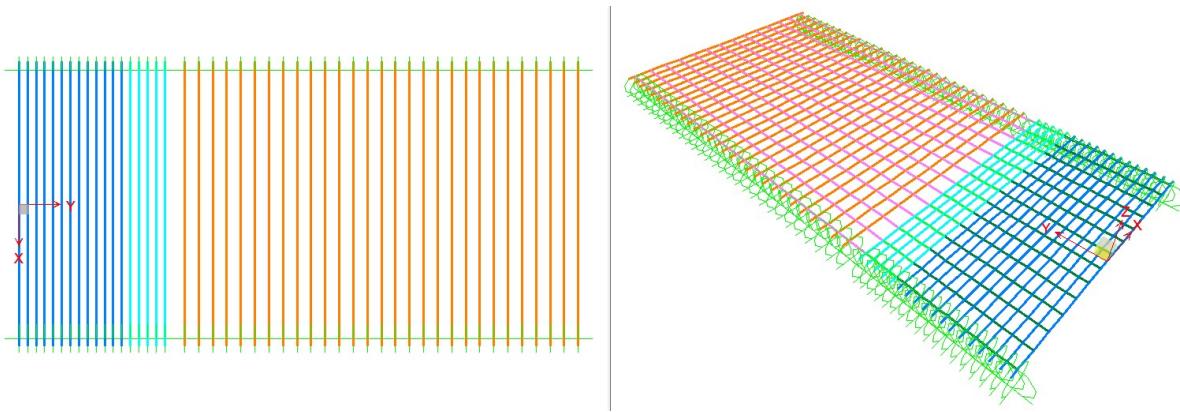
Vista 2D del modello FEM con indicazione unicamente delle travi, e vista completa del modello 3D
